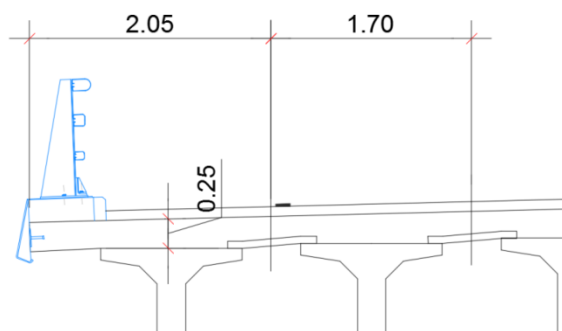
Dimensions des parties de dalle revenant aux poutres.
